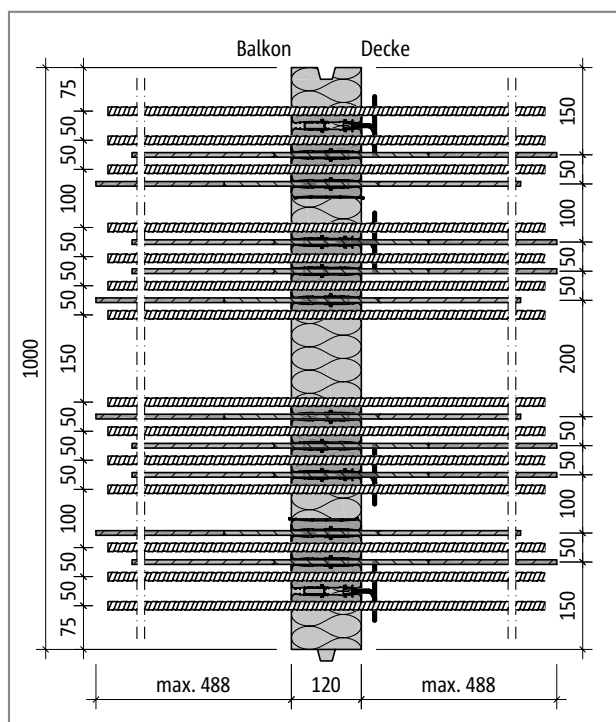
Schöck Isokorb® Typ KXT55-Combar-VV: Produktgrundriss
